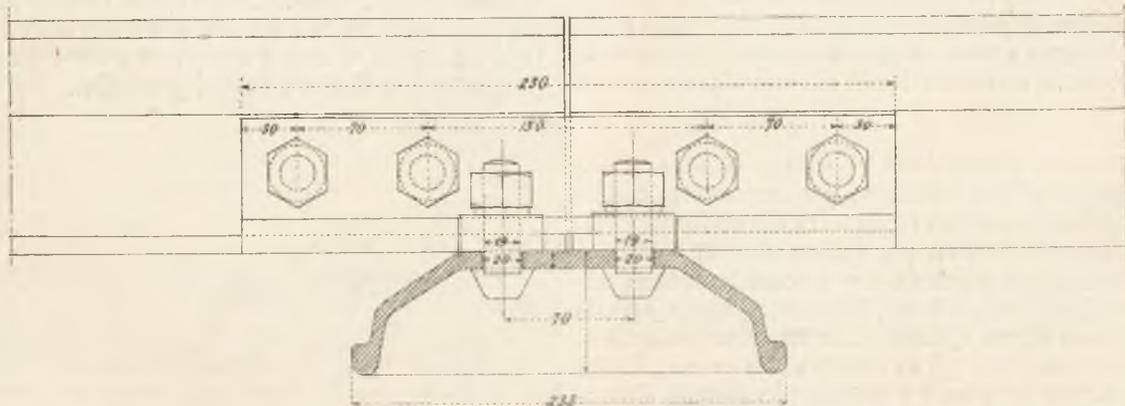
Armamento stradale. — Prospetto del giunto.
